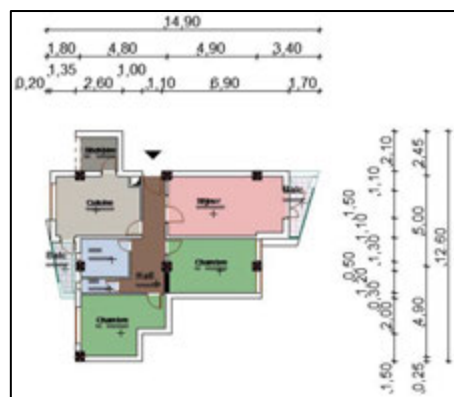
Logement F3 type 02 / Srcce : Auteur 2016
